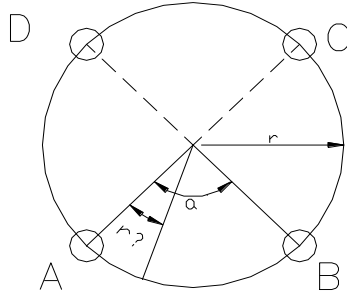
Trabe circular sobre cuatro columnas
